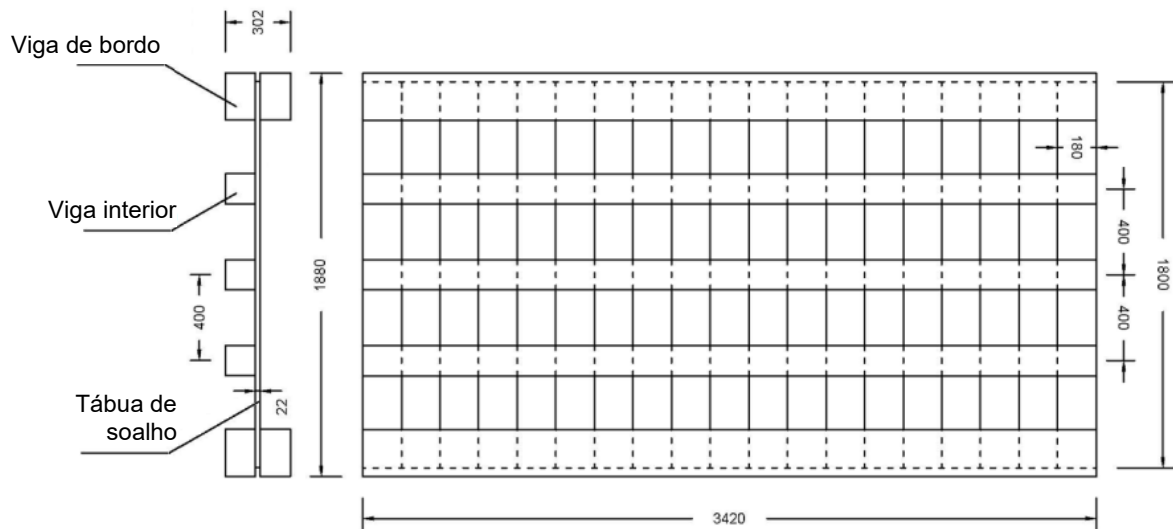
Esquema do pavimento sem reforço. (Dimensões em mm) (Fragomeli, 2015)
